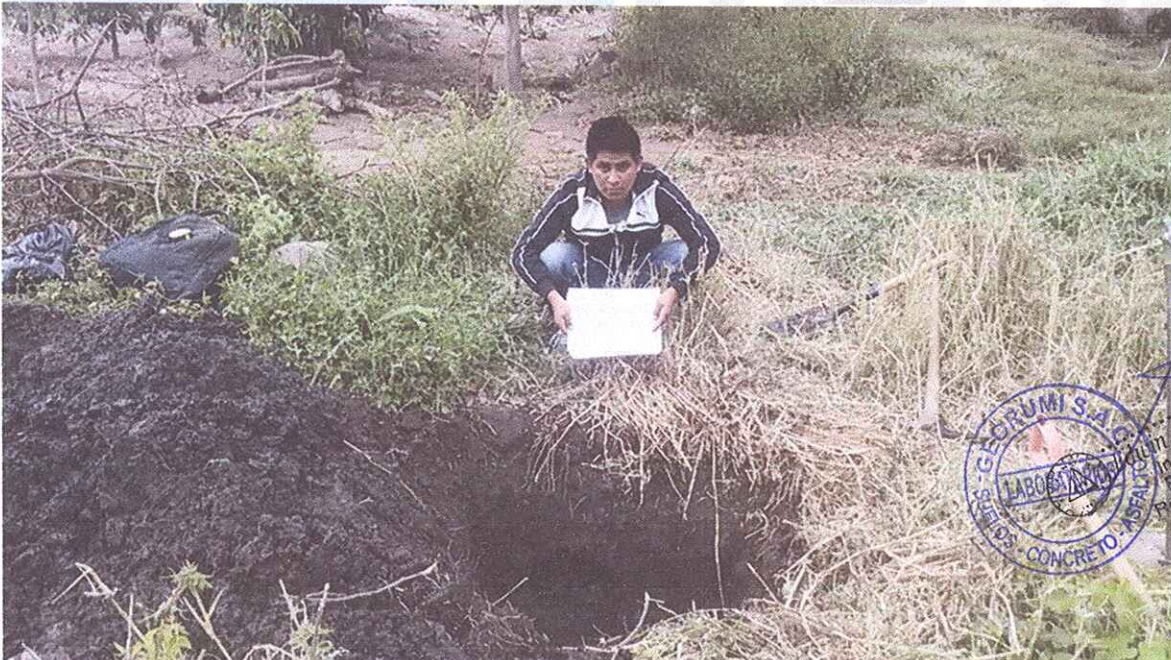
Se aprecia una vista general del lugar donde se excavo la calicata C-06.
